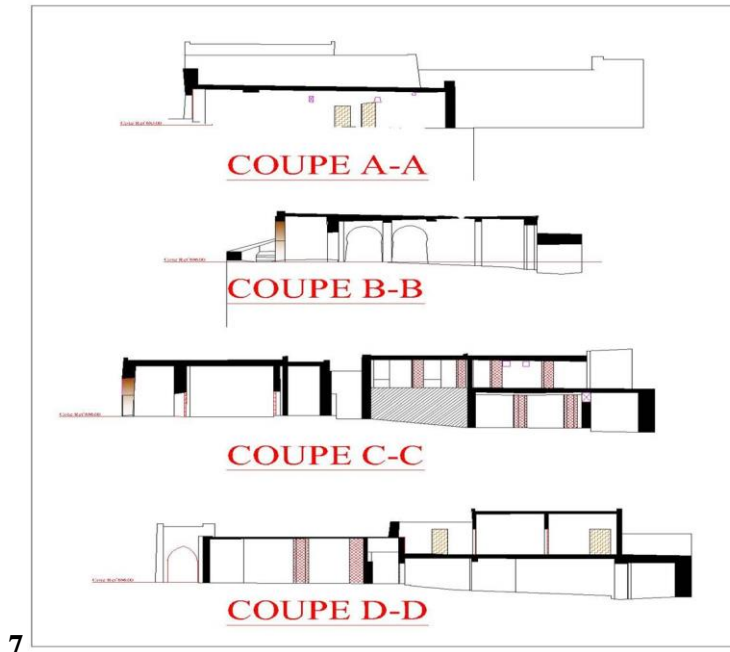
(Plan de coupe de la Zawya Tidjania à Boussemgoune)
